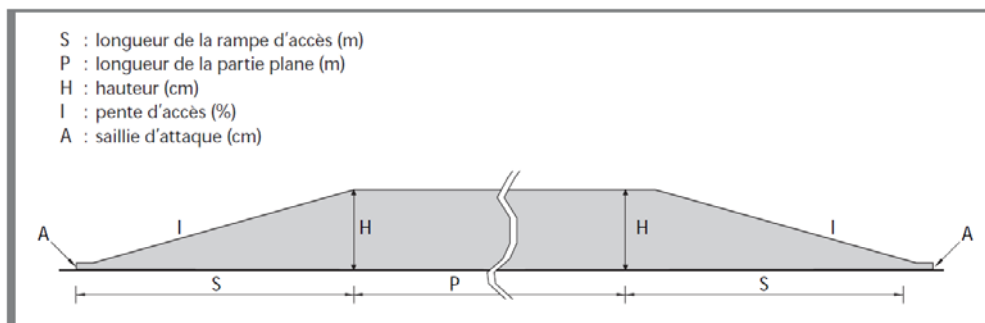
Profil général (trapézoïdal) et éléments caractéristiques d'un plateau avec rampes biseautées planes
